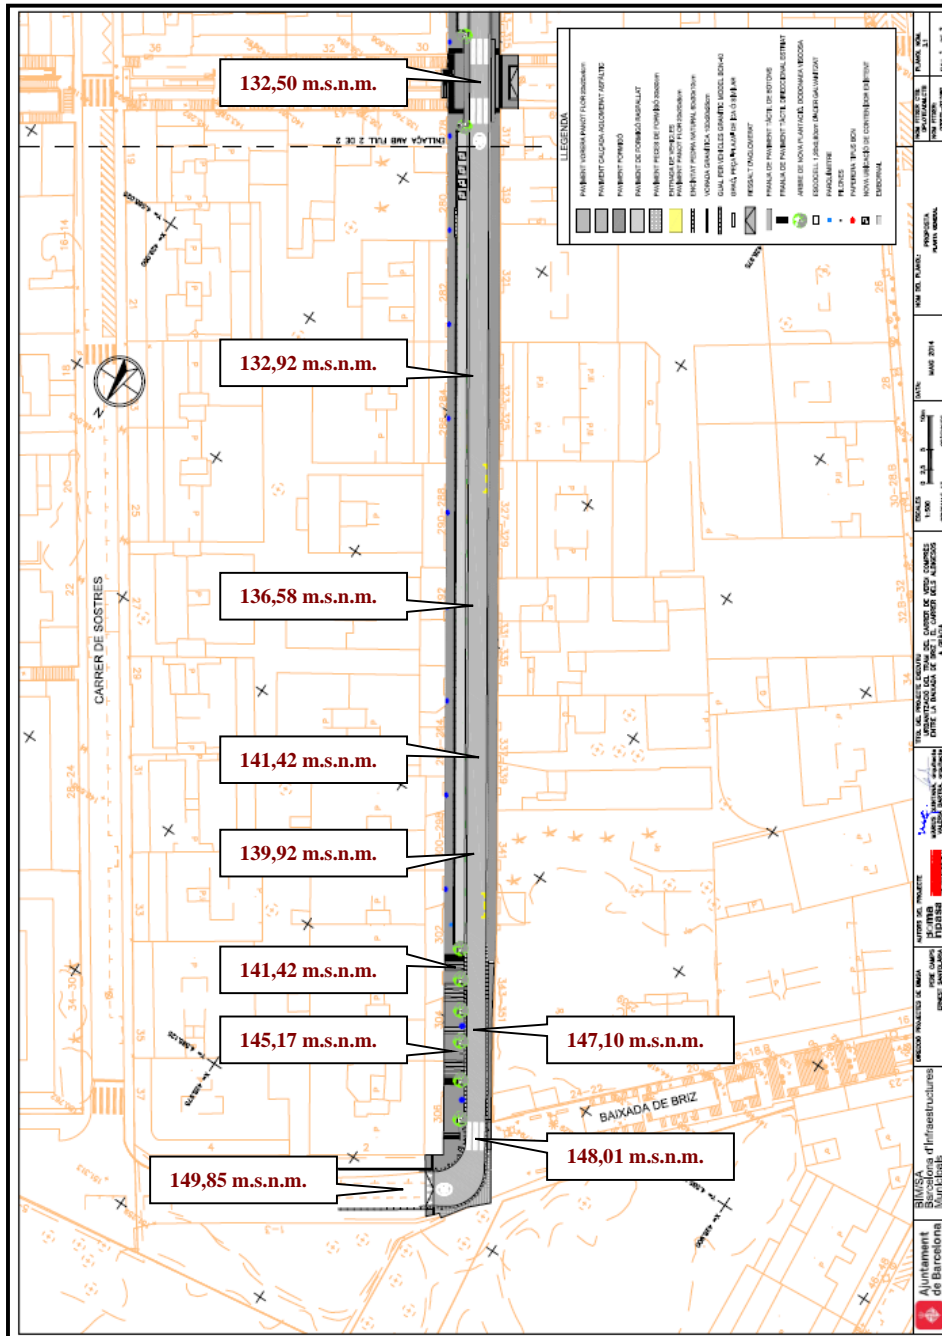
Planimetria facilitada per Ajuntament de Barcelona-Servei d'Arqueologia de Barcelona.
